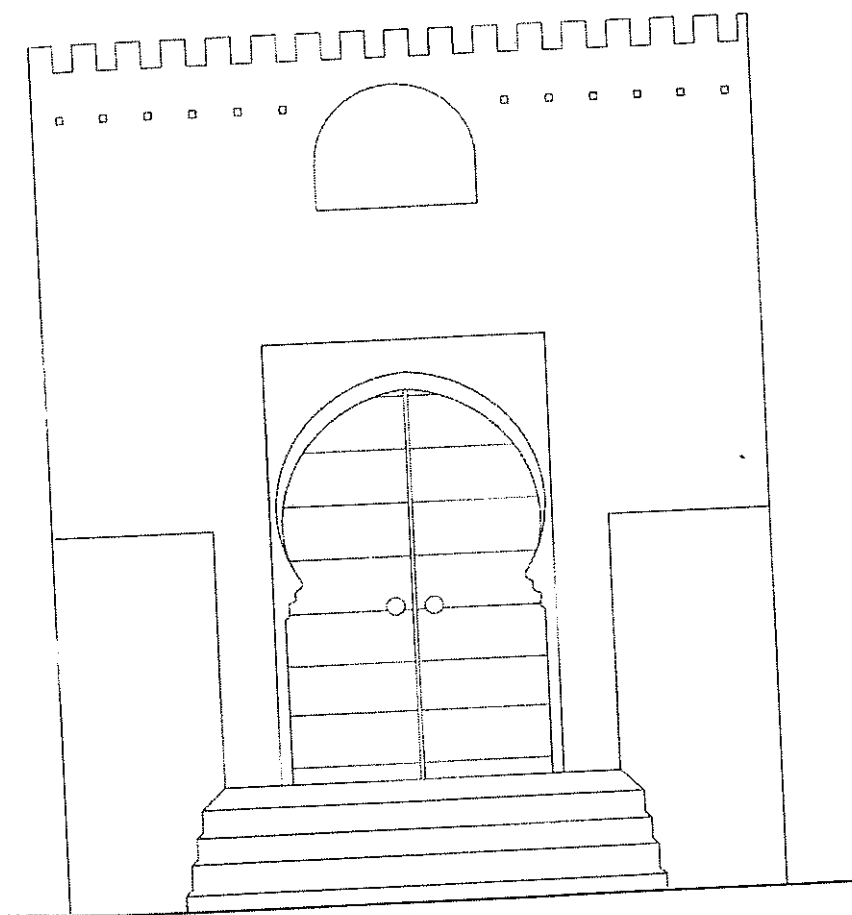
مسقط أفقي كروكي لبوابة ساحة الفرسان، عمل الباحث.
